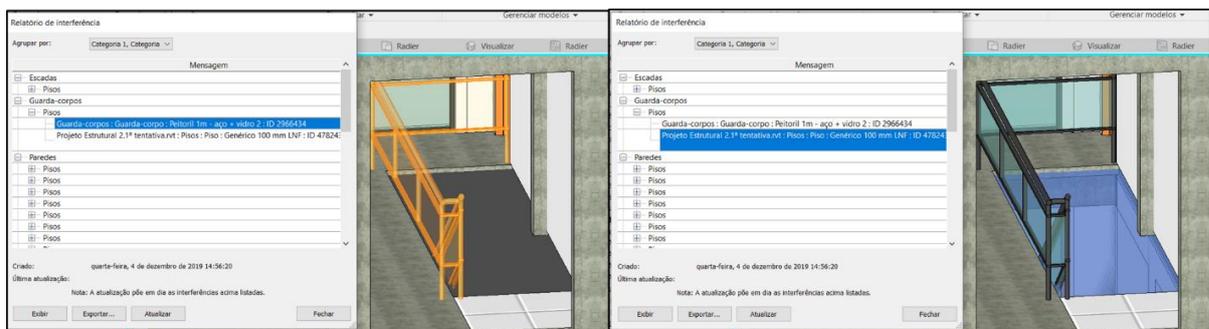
Exemplo de interferência entre escada e laje estrutural. (FONTE: acervo da autora).
